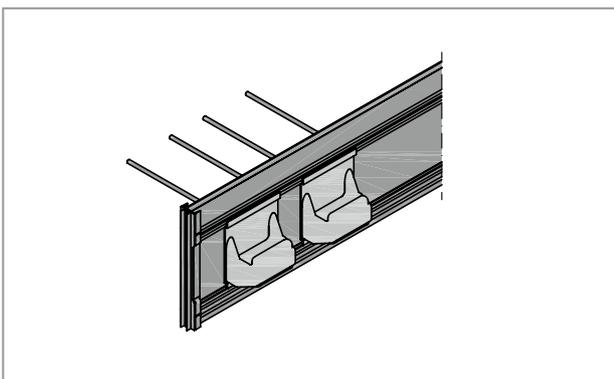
Schöck Tronsole® Typ T : Detail Tragkonsole positive Fertigung
